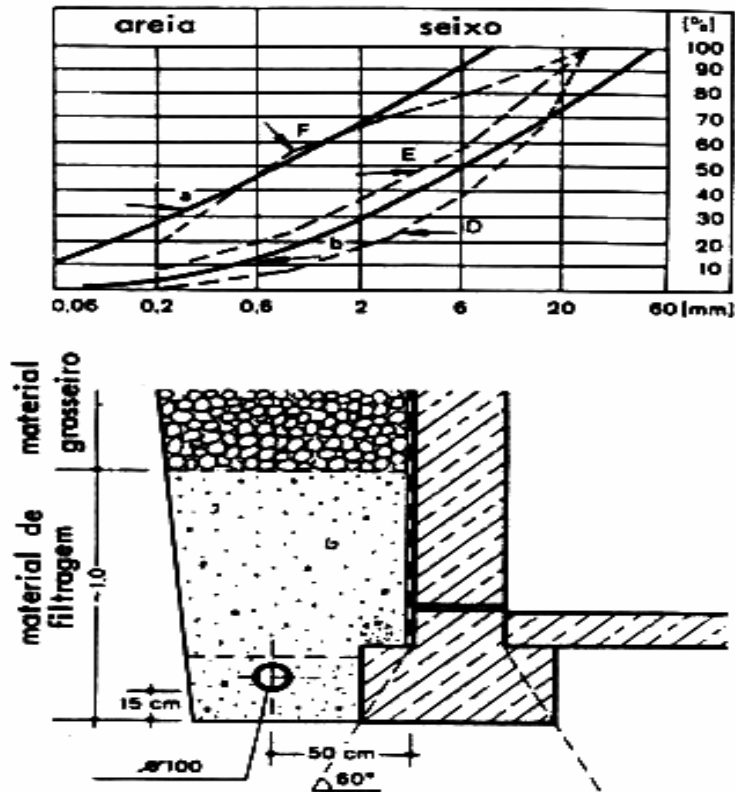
Disposição do tubo de drenagem e constituição da camada filtrante.
